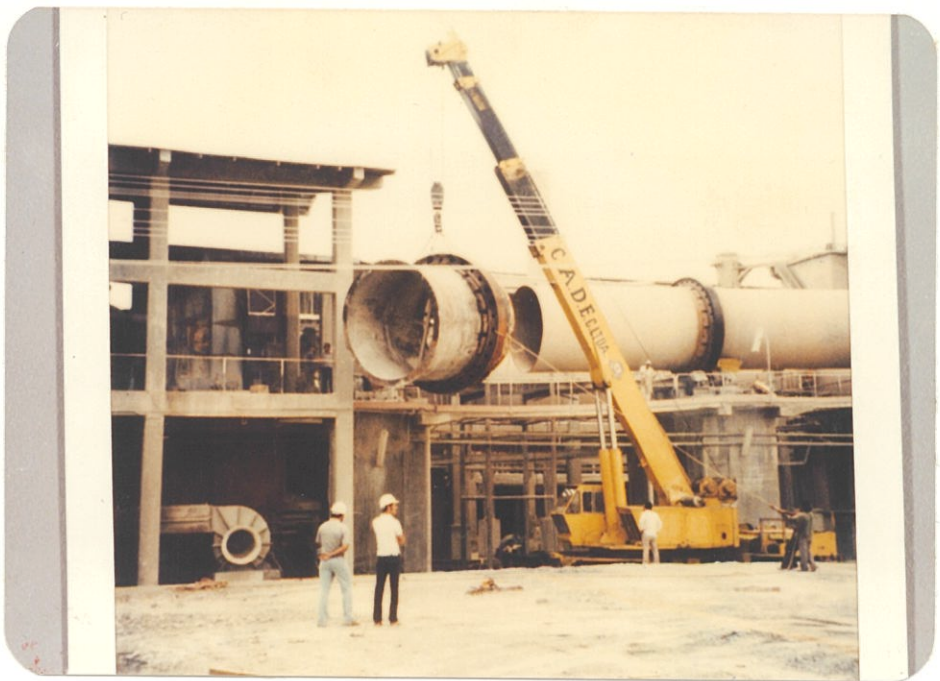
MONTAJE ZONA DE SOPORTE Y LLANTA 1.
